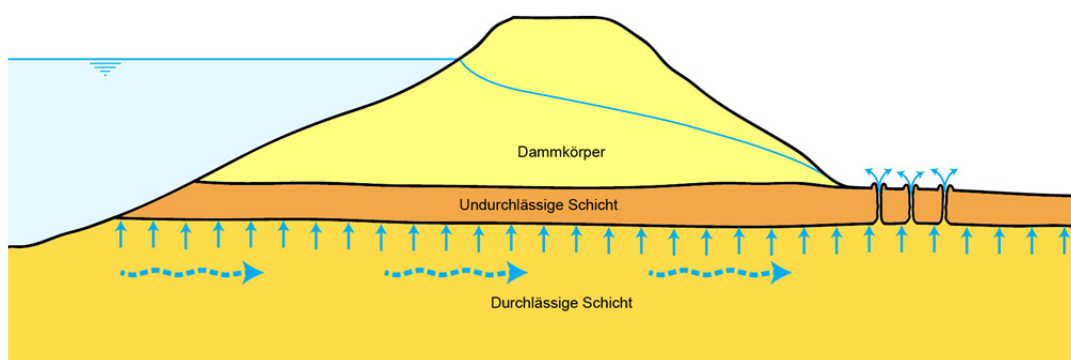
Hydraulischer Grundbruch am Dammfuss.
